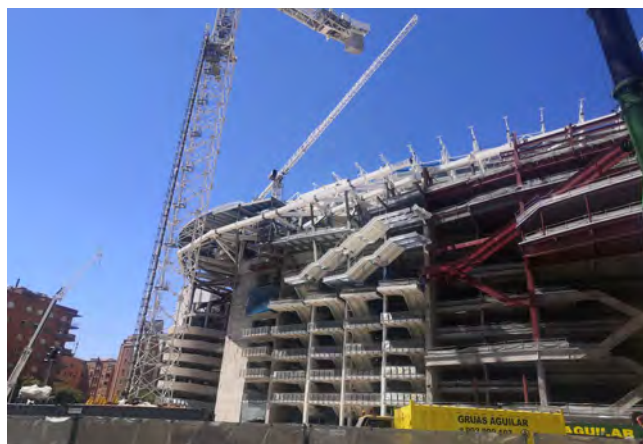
Foto de escaleras voladas del sur y escaleras perimetrales (por encima y en montaje).
